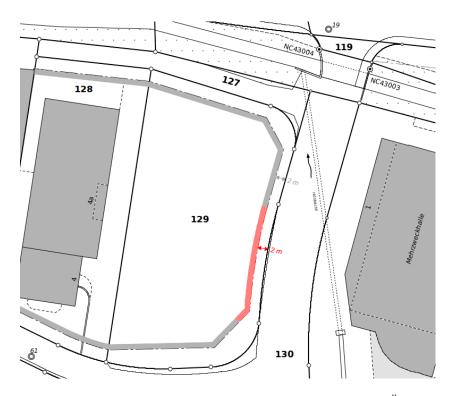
Mutierter Baulinienplan «Lindenweg West» mit rot markierten Änderungen
